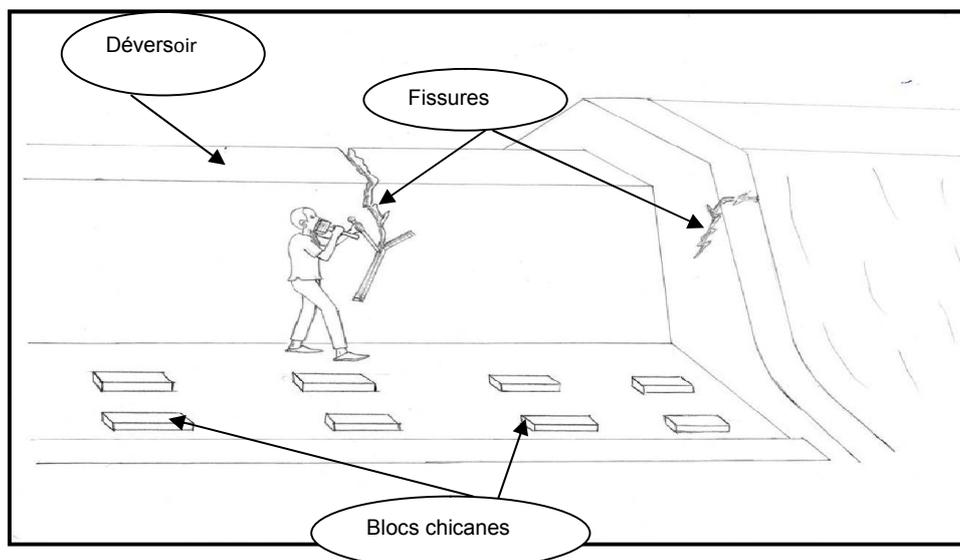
Réparation des fissures ouvrage en béton (1^{ère} partie)
